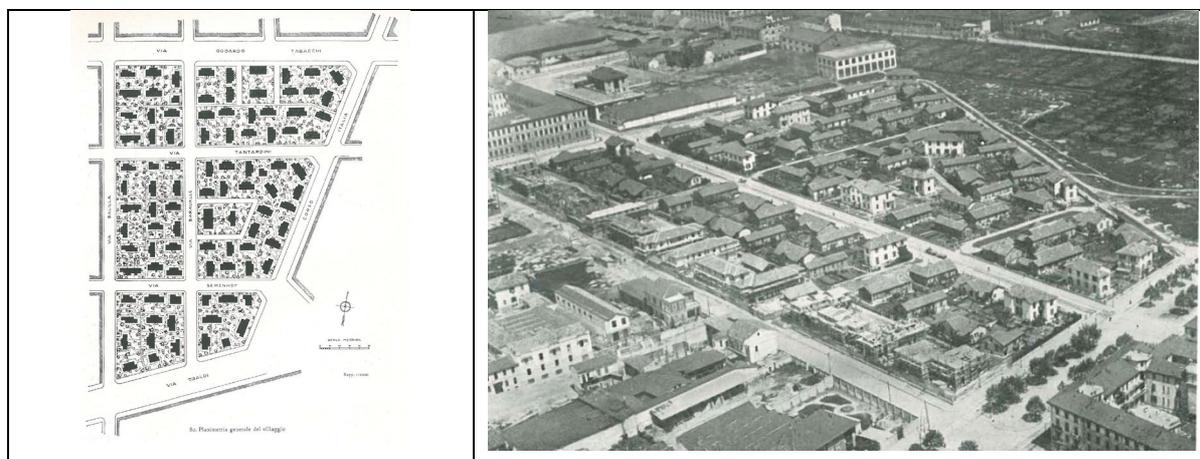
Villaggio Giardino Baravalle. Planimetria. e vista a volo d'uccello
